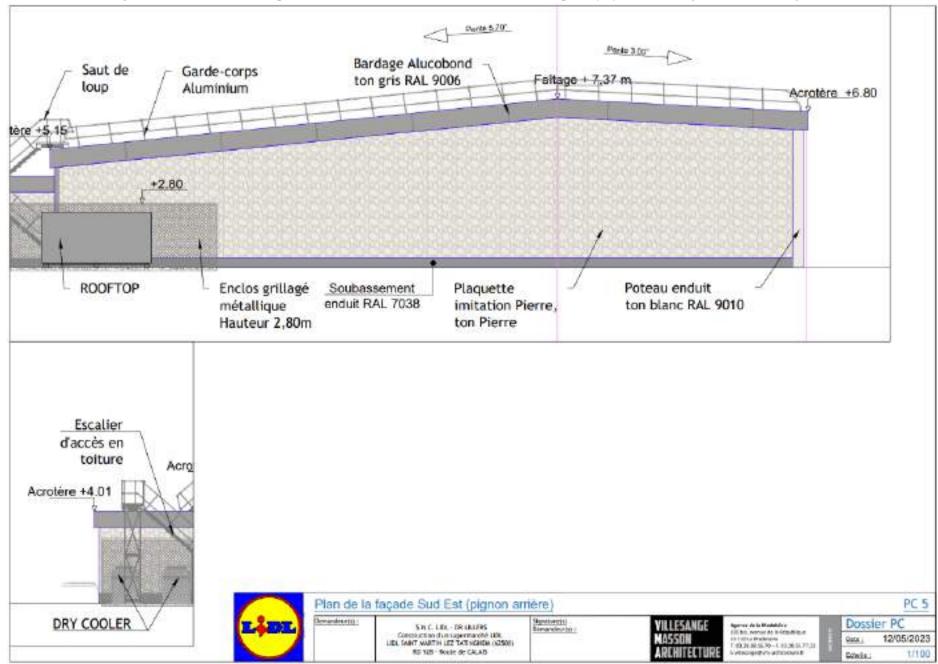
Plan de la façade sud-est ; Source : Villesange Masson Architecture
